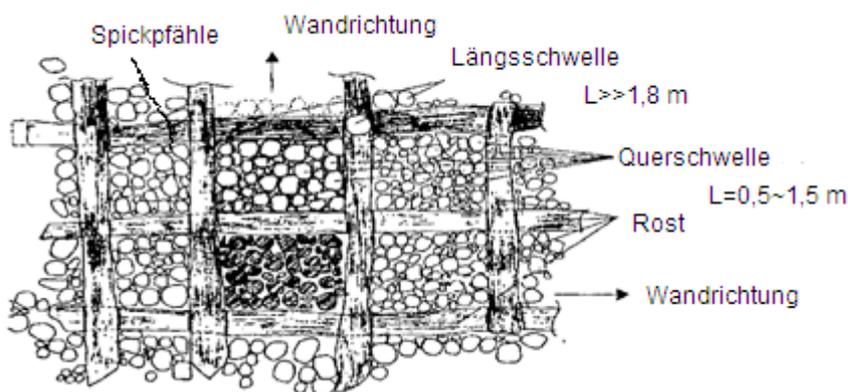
Kombinierte Spickpfahl-Schwellenrostgründung (Grundriss) [24]
